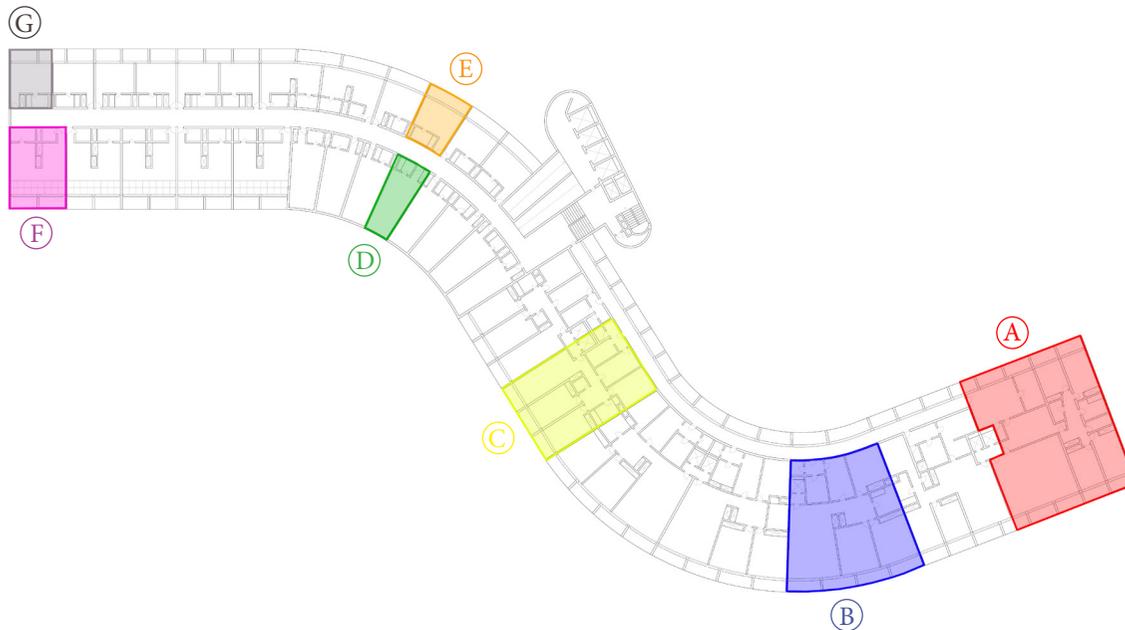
Esquema de la planta tipo indicando las distintas tipologías de vivienda.
